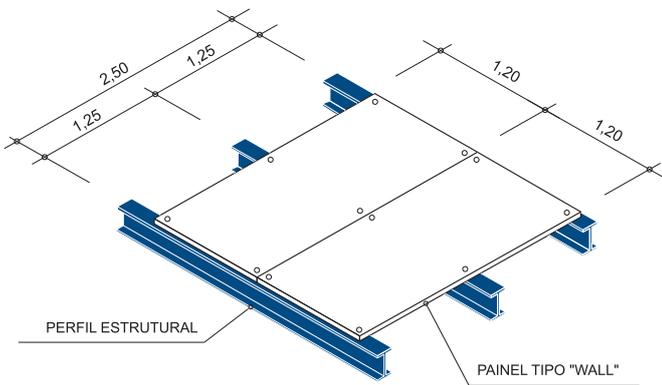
Disposição e fixação recomendada para instalação correta do painel tipo "wall"
